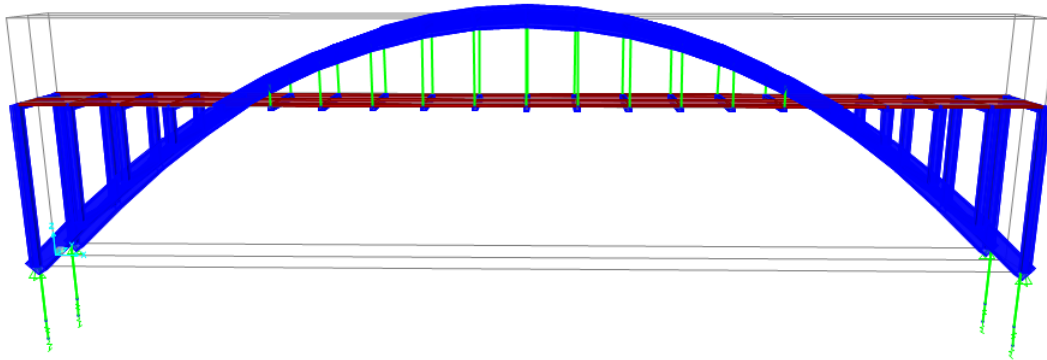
Variante 1. Fuente: elaboración propia (2022)
